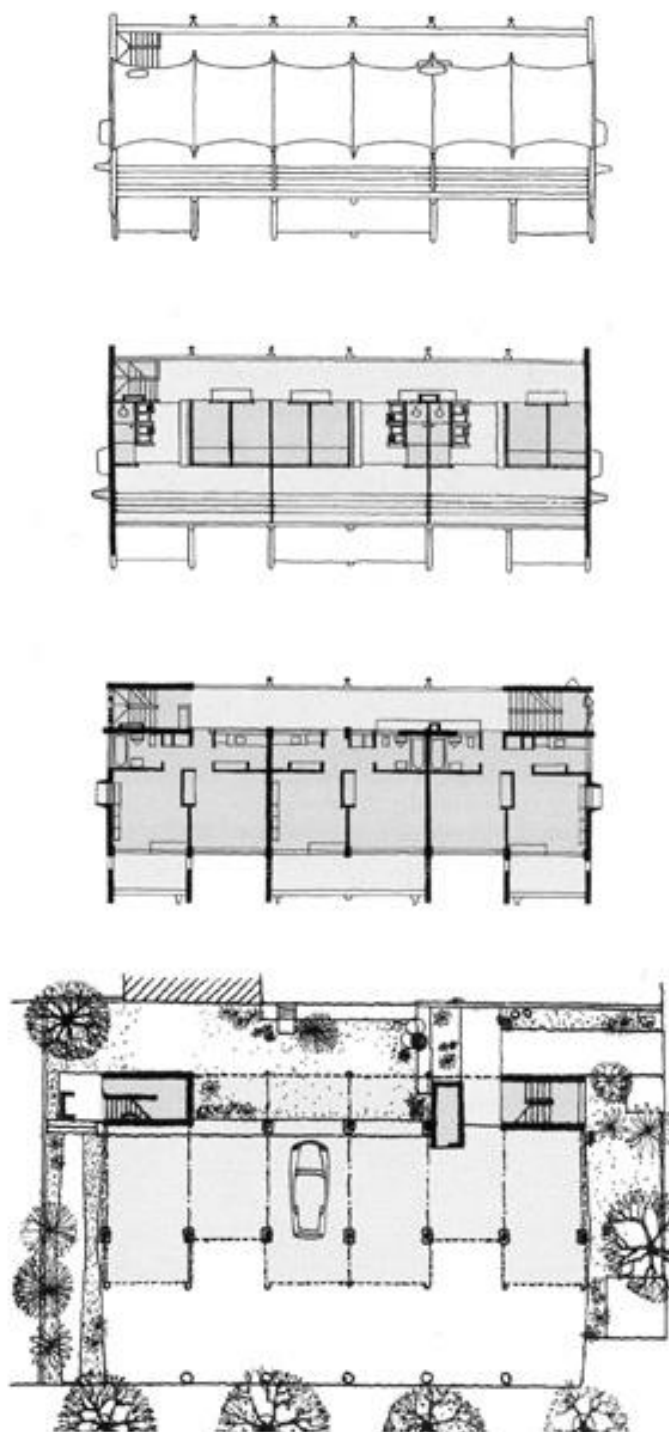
Plantas da cobertura até Ao Piso Térreo
